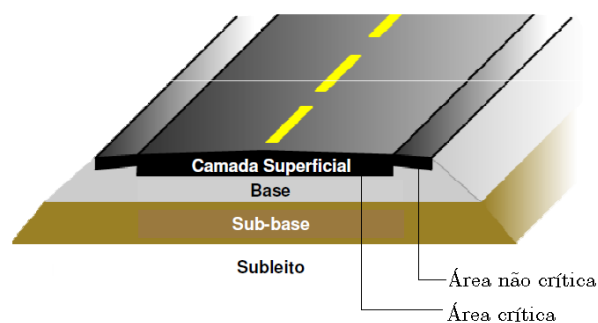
Estrutura tipo de um pavimento aeroportuário.
